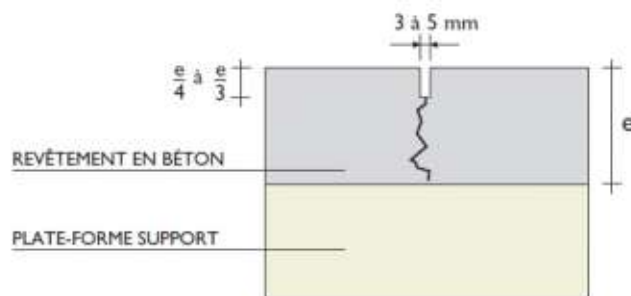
Schéma d'un joint de retrait (source : CimBéton).
